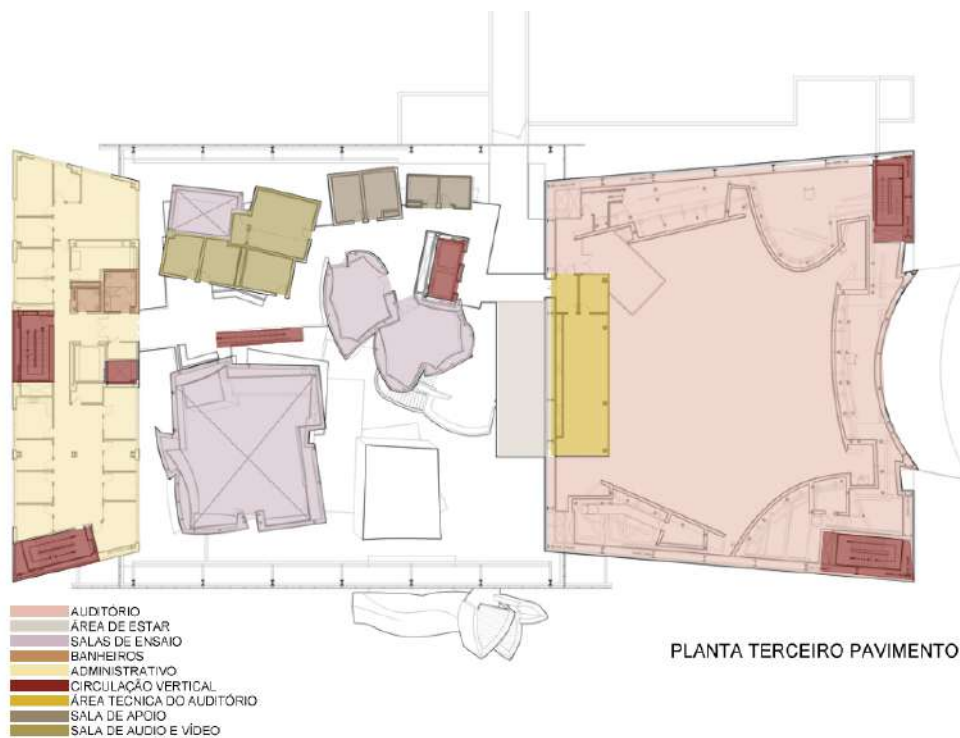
Planta terceiro pavimento. Fonte: ArchDaily editado pela autora.
